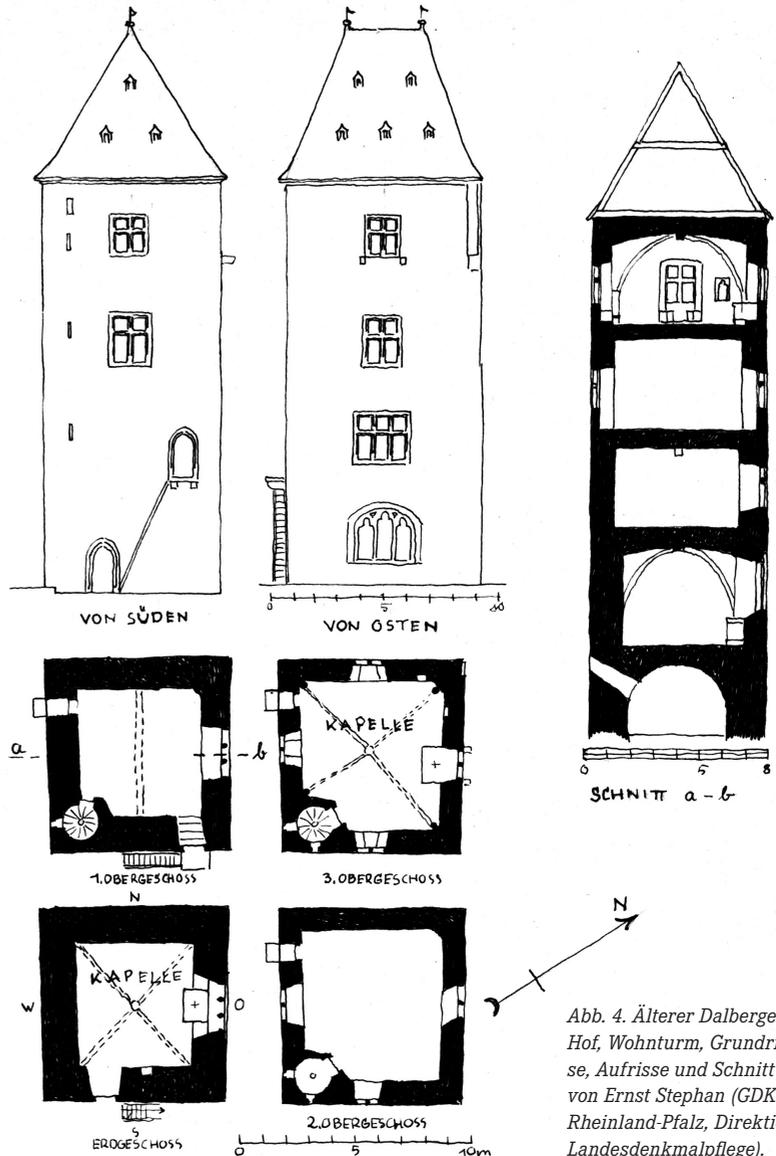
Älterer Dalberger Hof, Wohnturm, Grundrisse, Aufrisse und Schnitt von Ernst Stephan (GDKE Rheinland-Pfalz, Direktion Landesdenkmalpflege).
